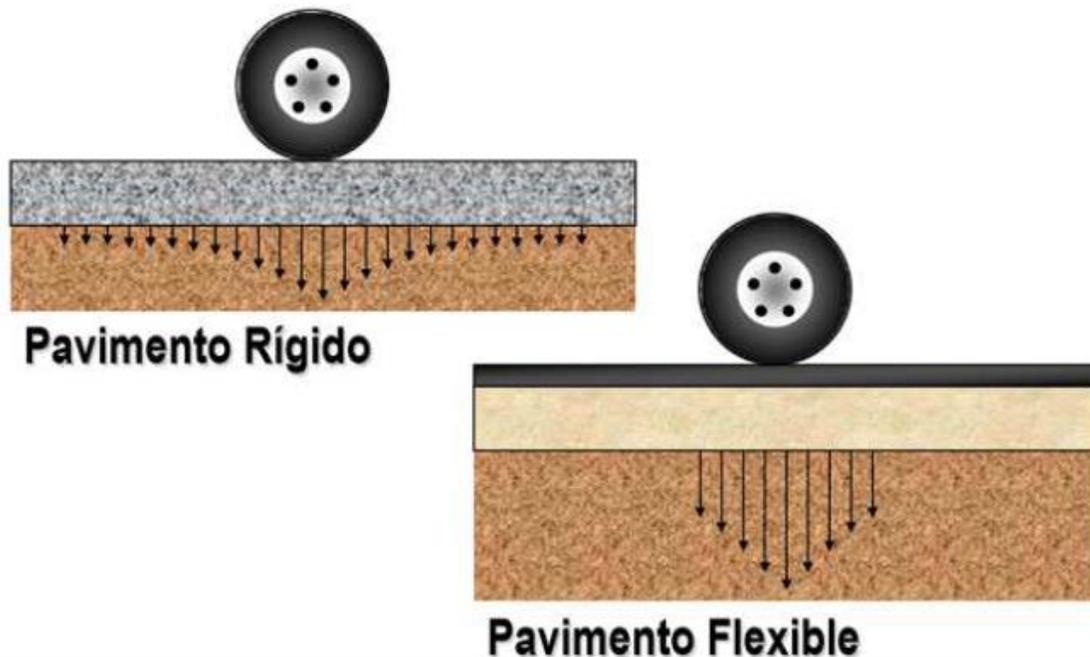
Esquema de distribución de cargas de un pavimento rígido y uno flexible (Ing. Claudio Giordani, Ing. Diego Leone, pavimento)
